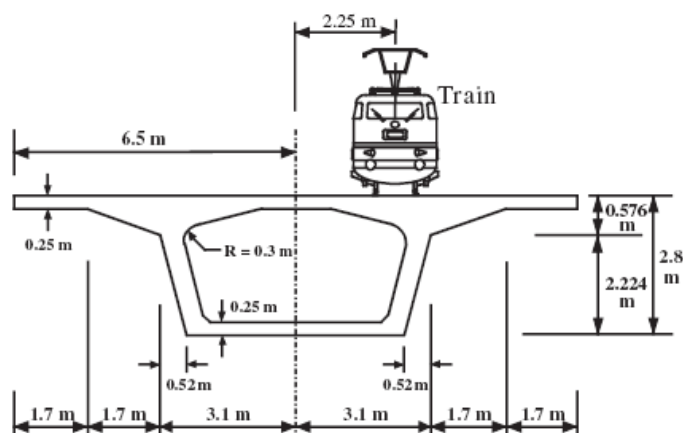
Secção transversal da ponte em betão pré-esforçado em Taiwan (Fonte: Ju *et al.*, 2006)
